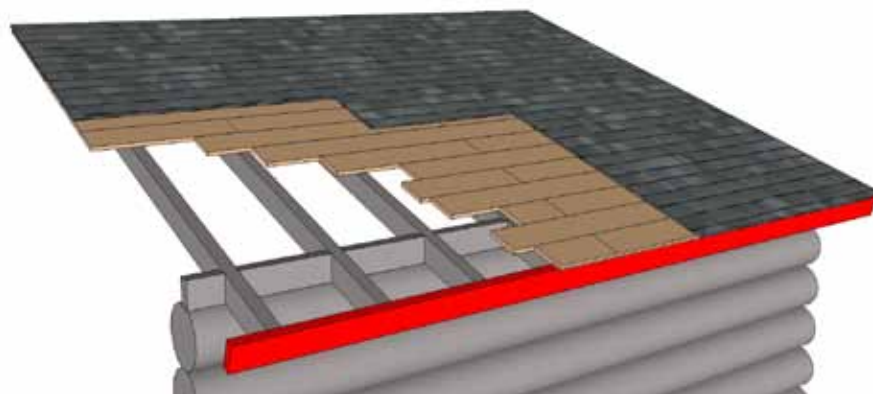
Situation existante : Les toitures sont constituées d'un platelage de bois en 1'' x 6'' posé sur des chevrons de 2'' x 4'' à tous les 16'' d'entraxe avec un entrain retroussé en 1'' x 6'' tous les 2 chevrons. Le platelage est recouvert de bardeaux d'asphalte trois pattes.
